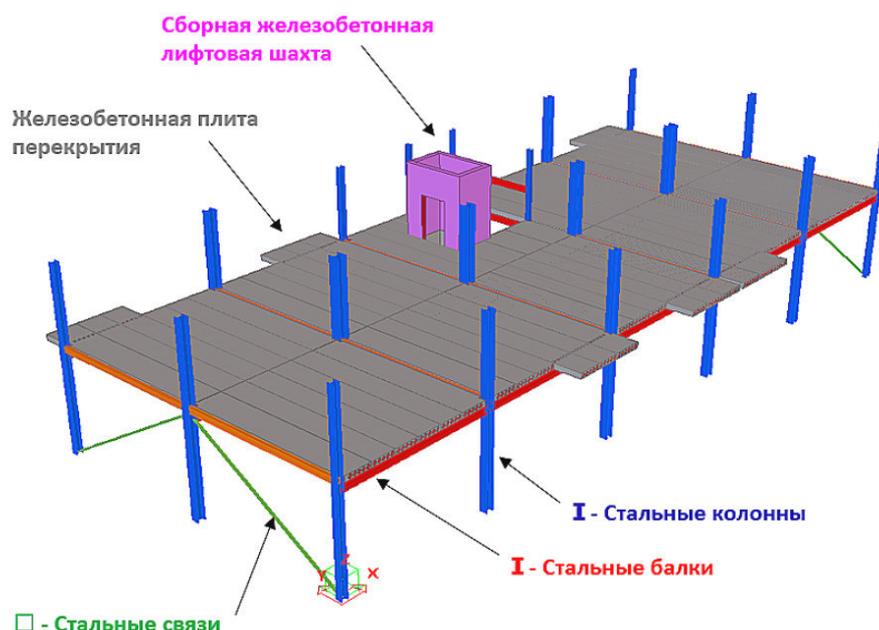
Пример фрагмента каркаса со сборной шахтой лифта
